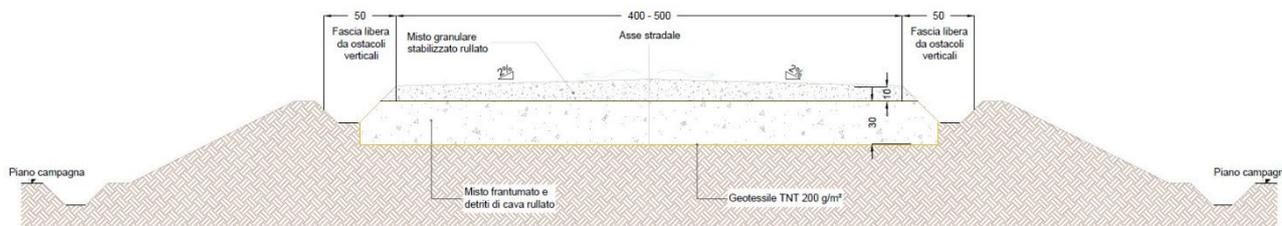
Sezione tipo pista di impianto su rilevato; misure in centimetri
